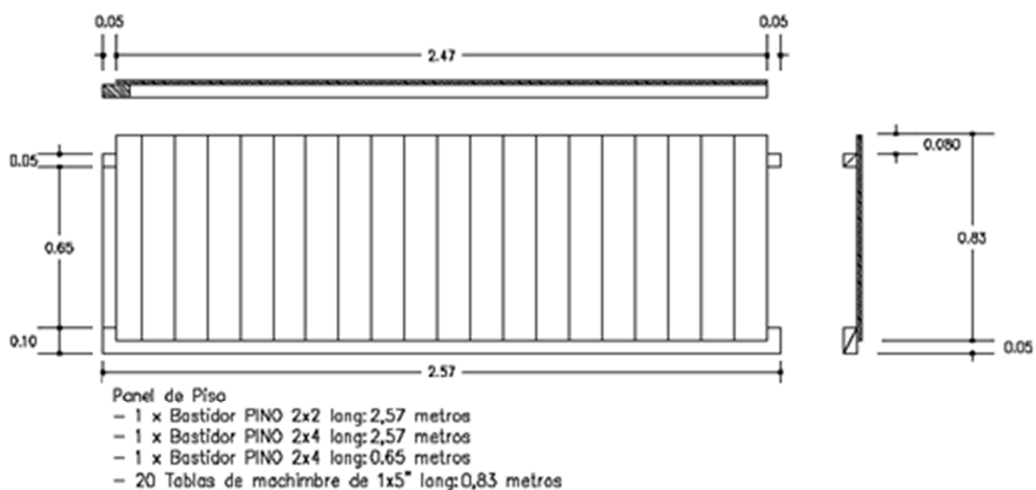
Detalle constructivo de los paneles de piso. Fuente: Documentación provista por TECHO.
